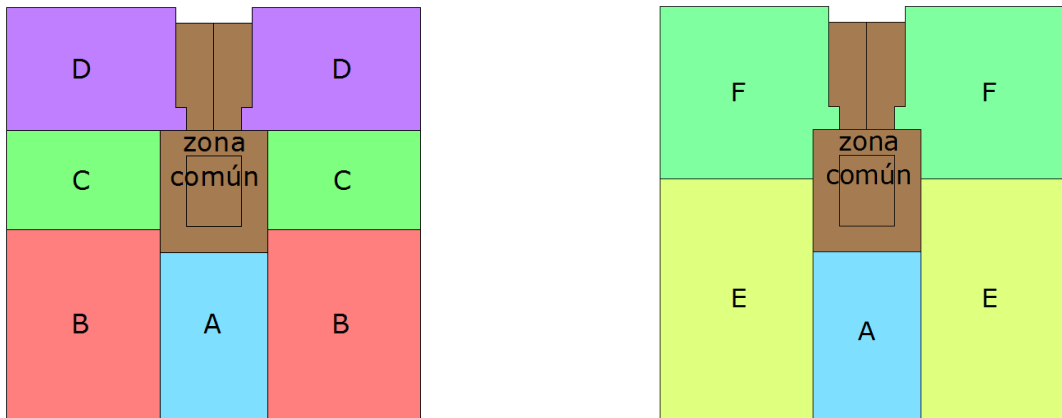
Plantas tipo de viviendas. Fuente: elaboración propia
